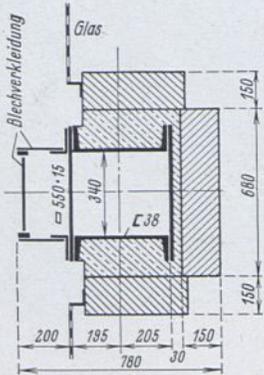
Querschnitt der rückwärtigen Stütze mit Betonummantelung und Werksteinverkleidung.
